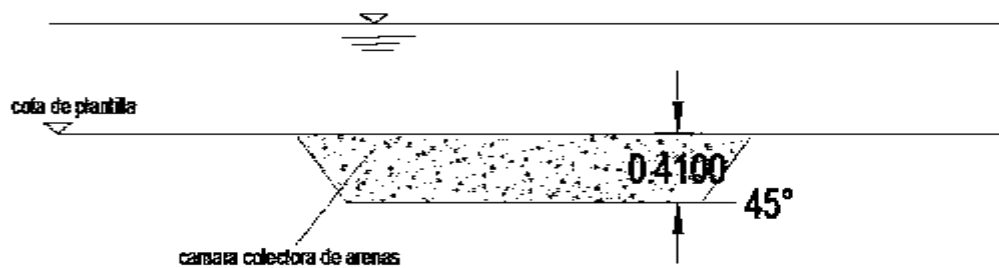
vista en elevación de la cámara colectora de arenas.
